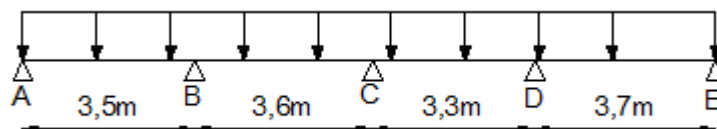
schéma statique de la poutre reposant sur cinq appuis.
